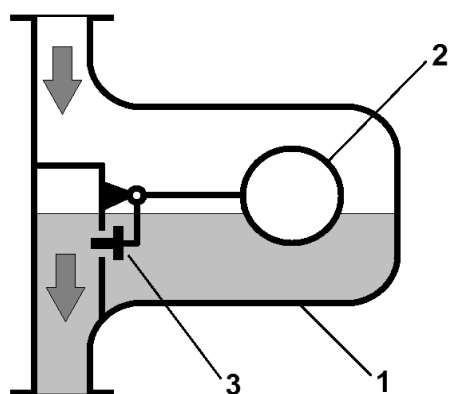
Схема устройства конденсатоотводчика со сферическим закрытым поплавком: 1 – корпус; 2 – поплавок; 3 – клапан
